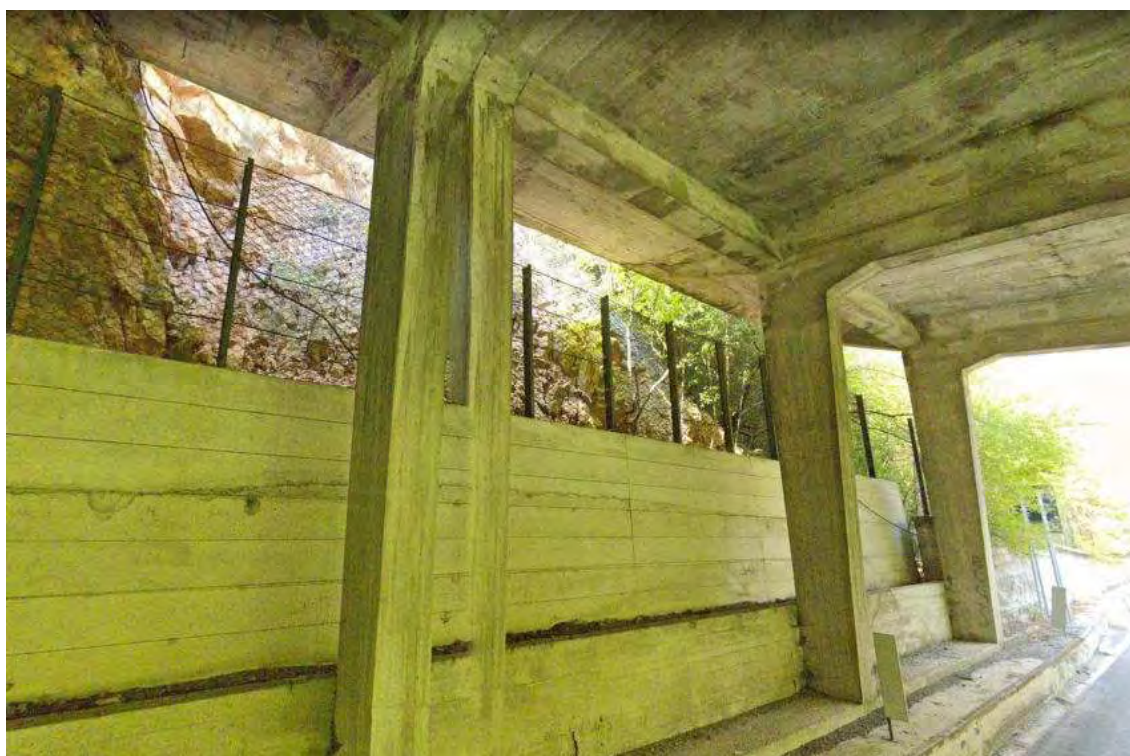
Particolare consolidamento Galleria parietale- direzione Ponte-Borgo Cerreto
